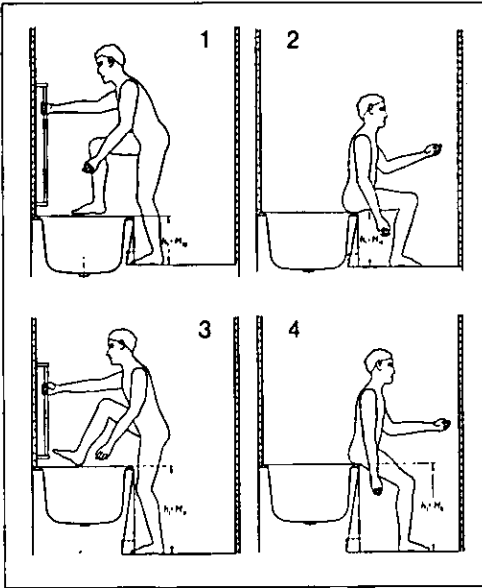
Badewannenbenutzung und Einbauhöhe [2]
